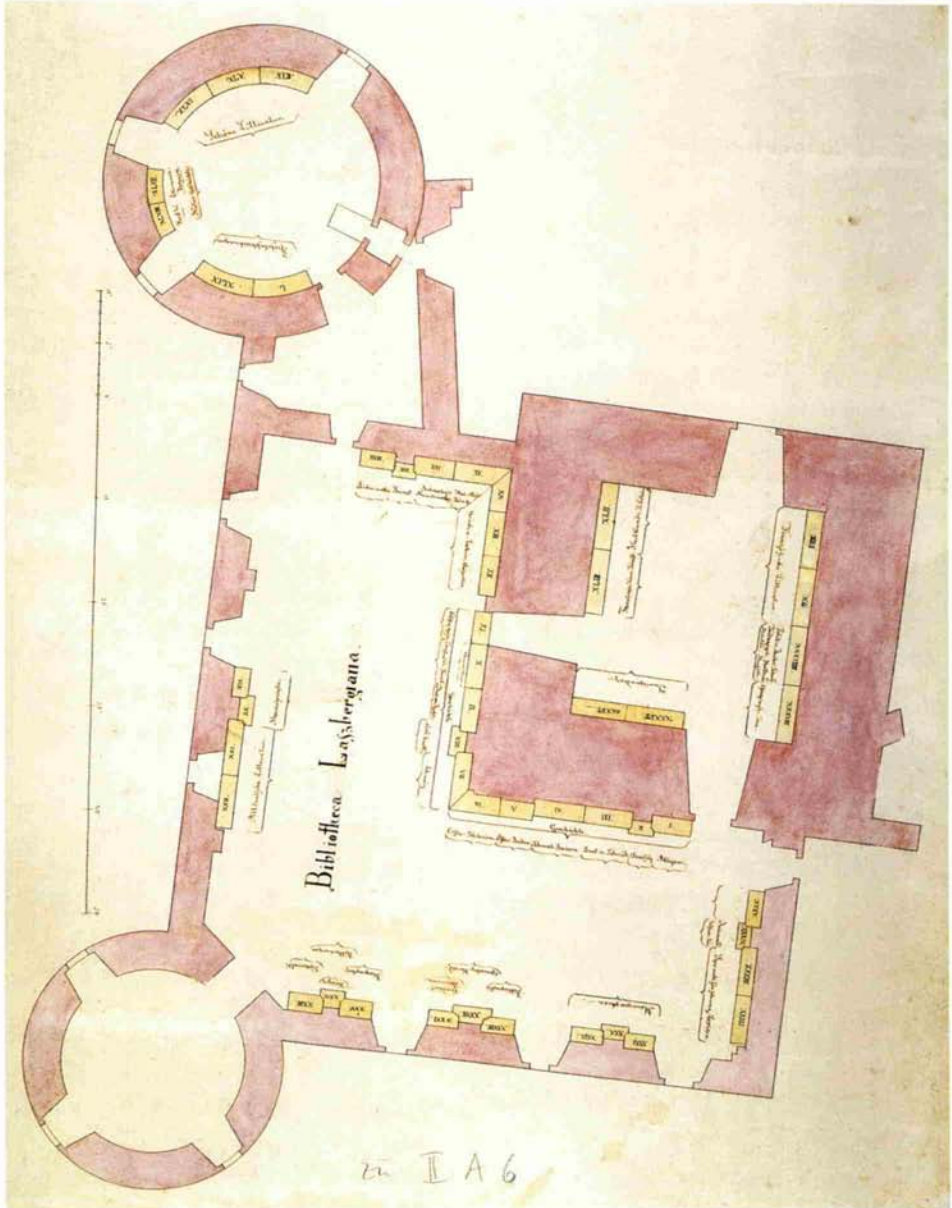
Teilgrundriss der Meersburg mit Bibliotheksplan - Laßberg Nachlass K 2912
